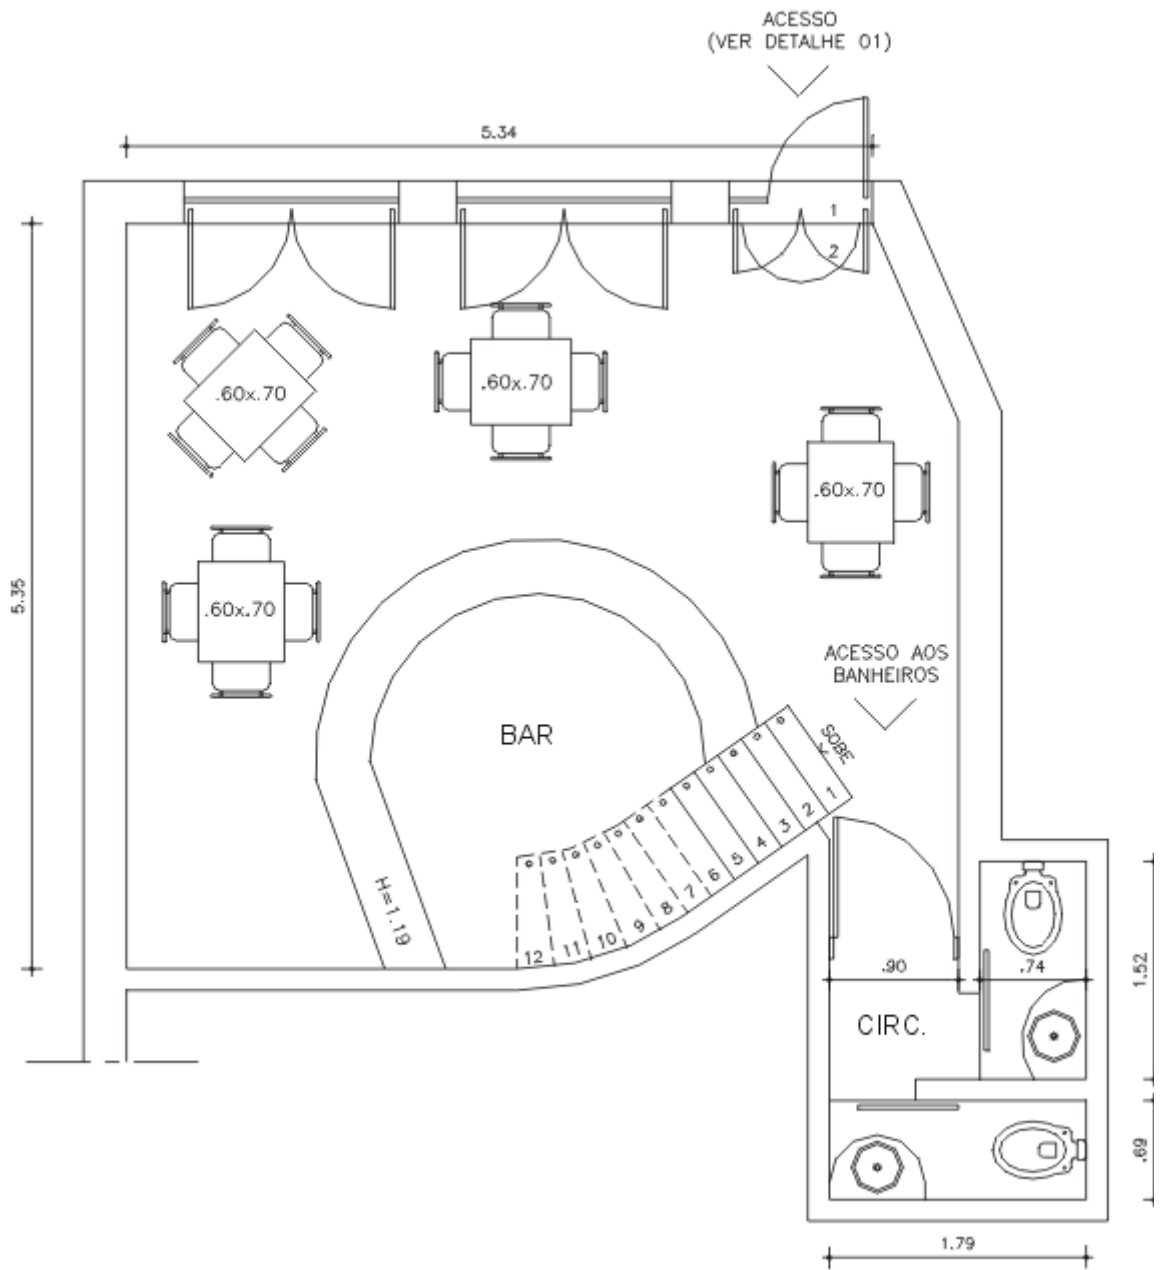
Planta baixa (lay-out) do pavimento térreo do “C”.
